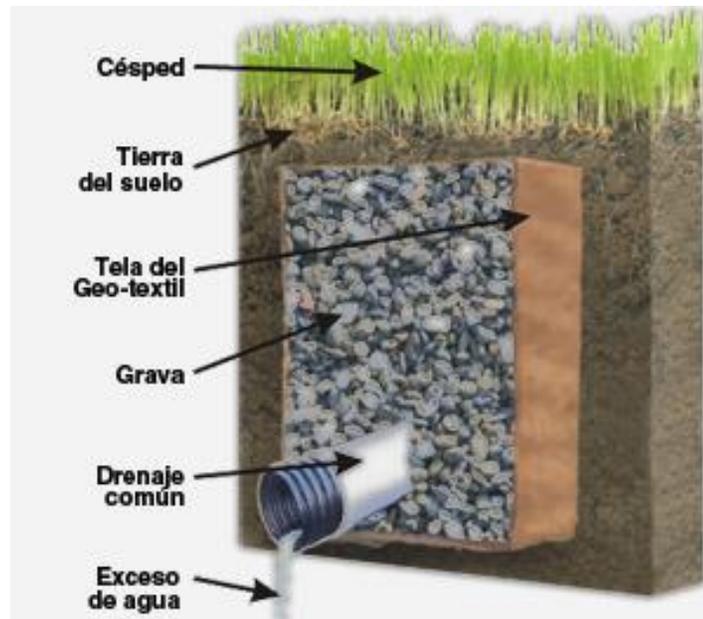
Detalle típico de drenaje francés (Fuente: <https://www.pinterest.com.mx>)
